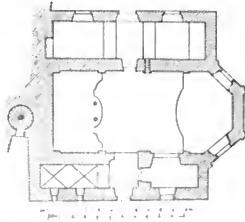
Obříství. Grundriss der Kirche.
